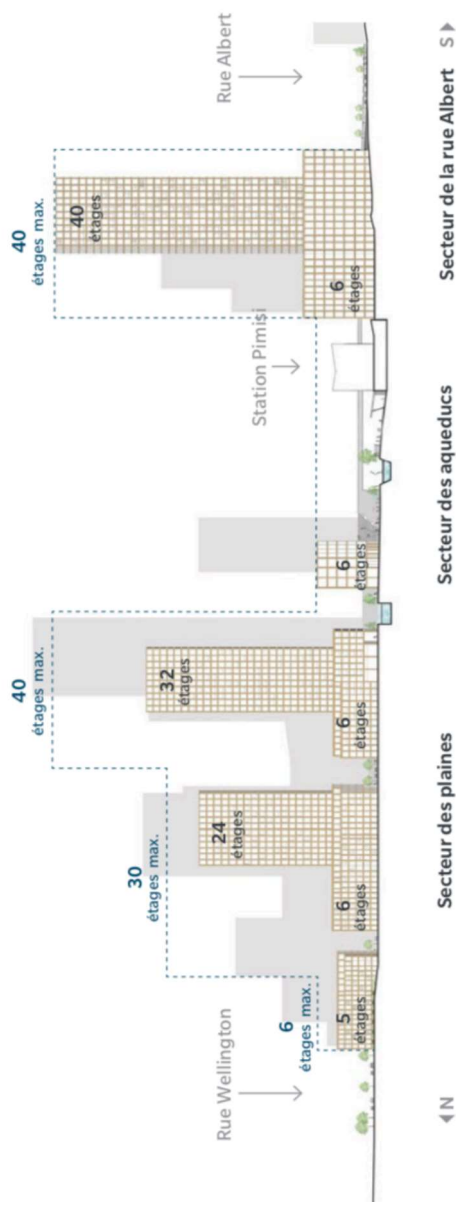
| Élévation (nord-sud) illustrant la transition de la hauteur des immeubles, du secteur des plaines au secteur de la rue Albert
